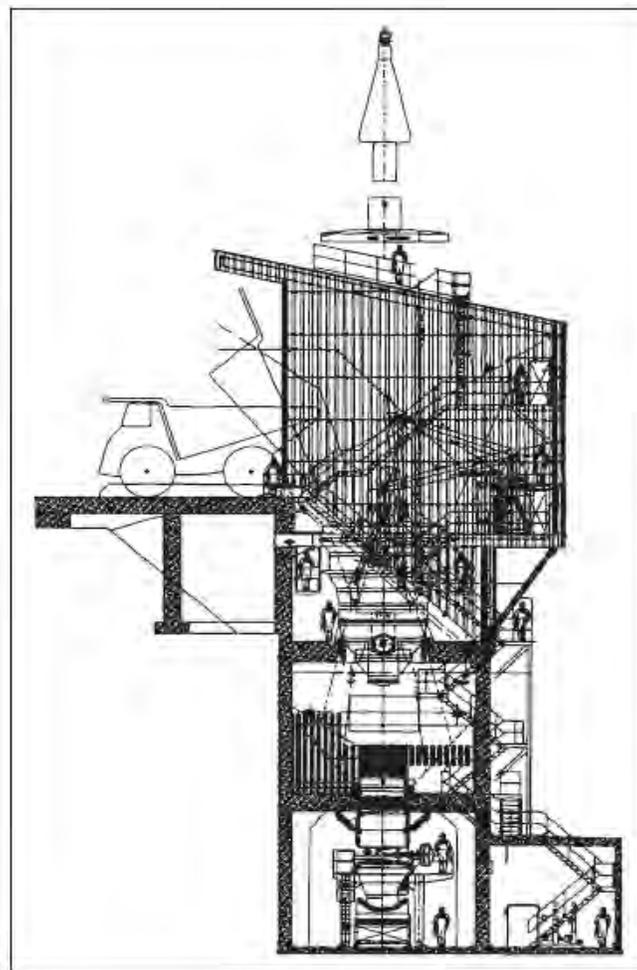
2 Chancadora instalada sobre estación de acero estructural. Fuente (Darling, 2011)
